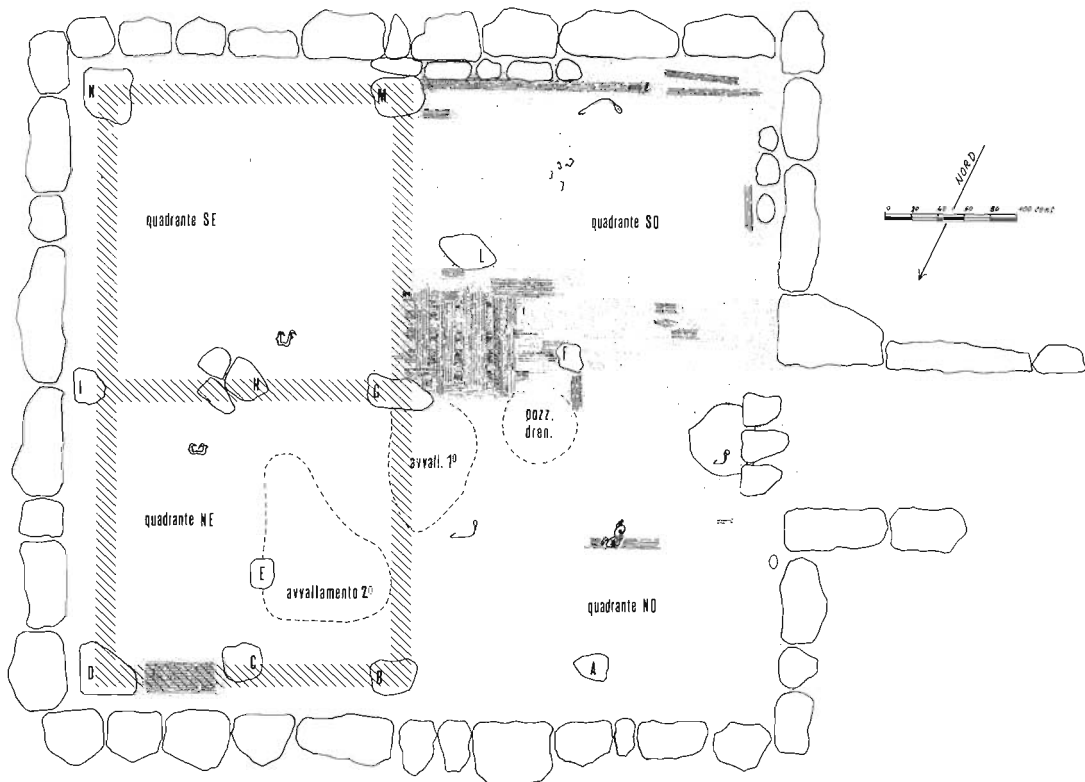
Tracciato in pianta del sistema essenziale delle travature orizzontali dell'elevato.
